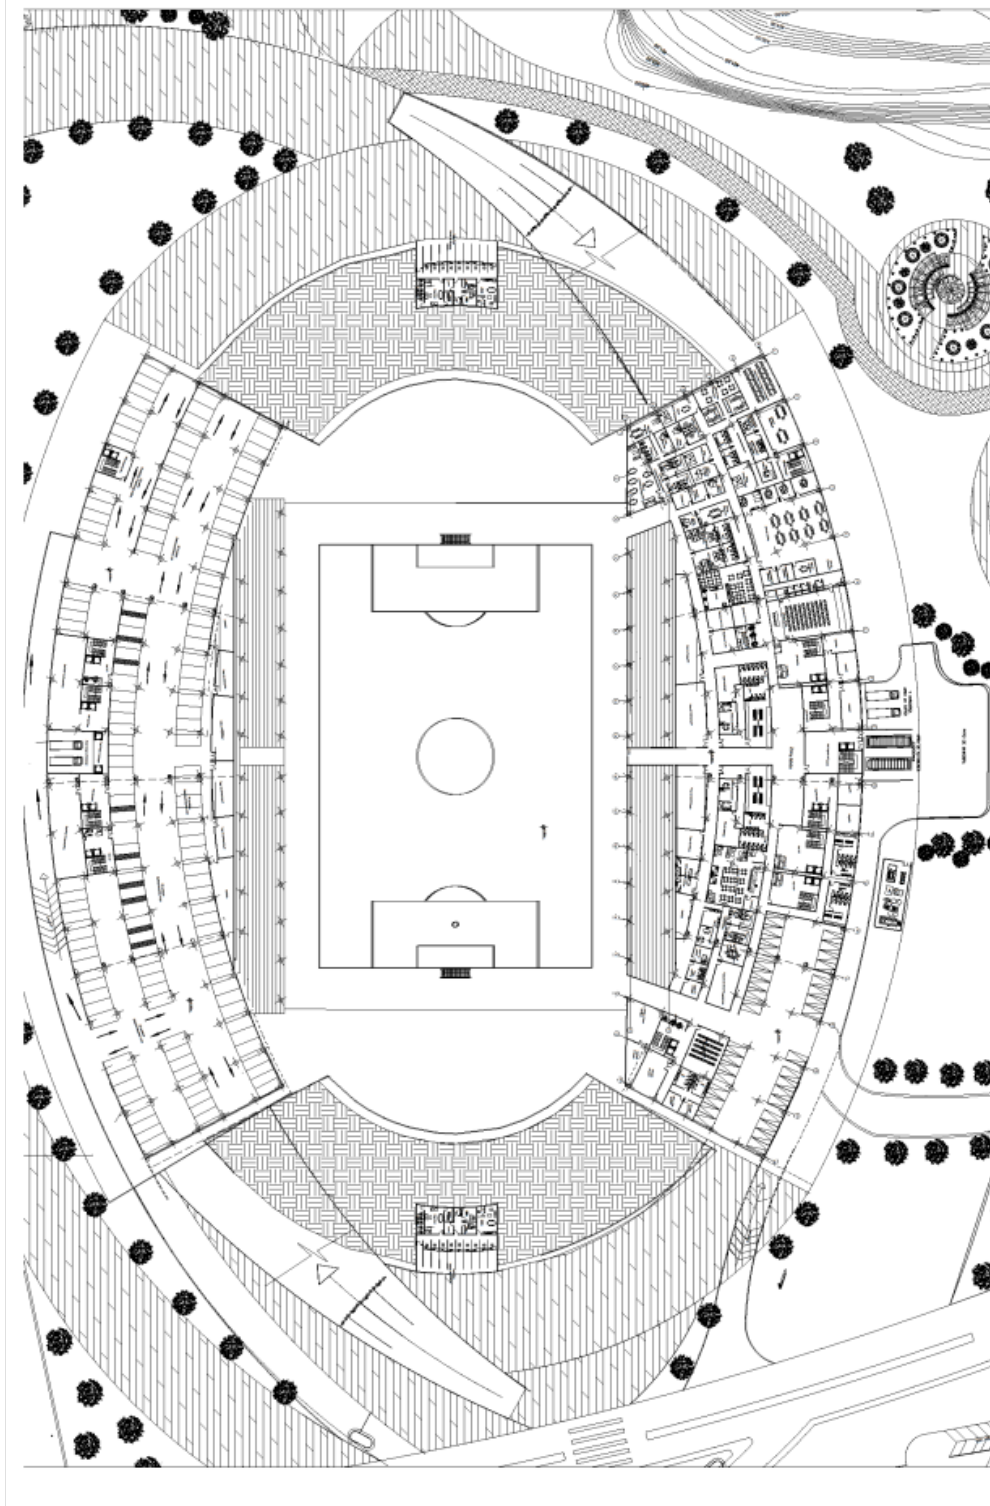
Nivel -8.80, Planta Sótano 1, Nivel de Juego.
